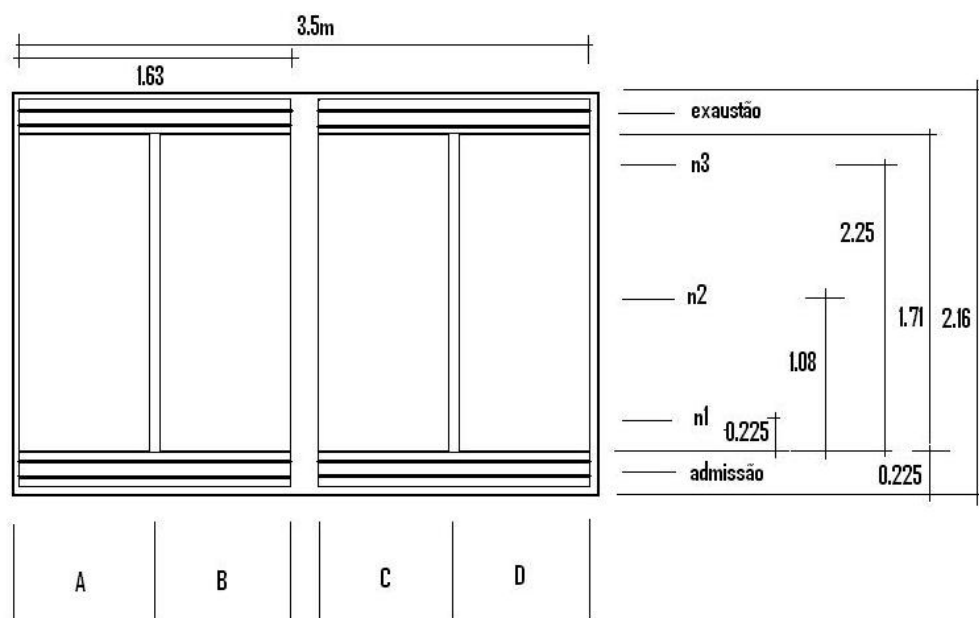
Vista pelo interior da Fachada Ventilada
